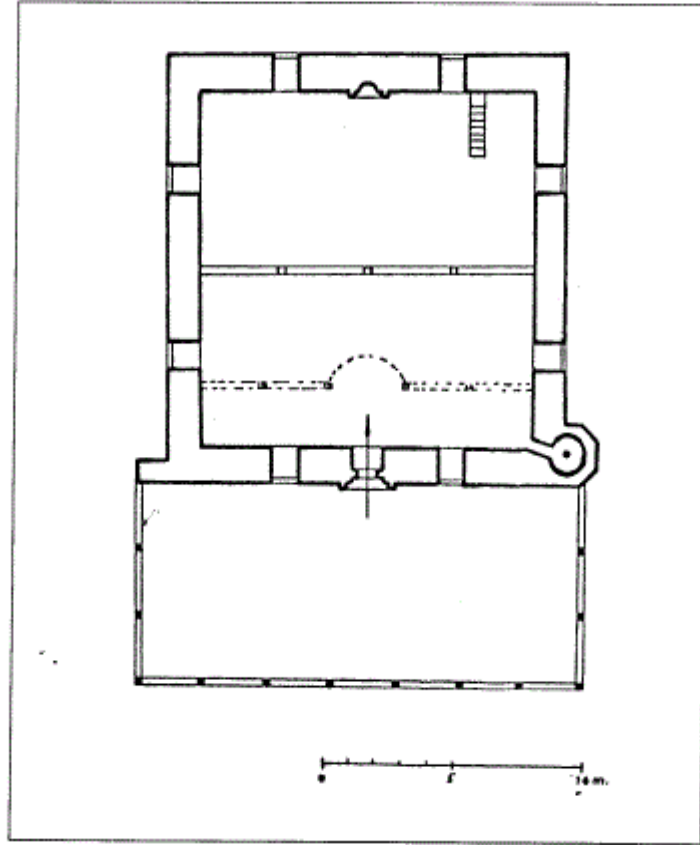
مسقط أفقي لمسجد سوكللو محمد باشا المعروف بمسجد باب العزب (عزب قايي) بإستانبول (عن : كوران)
